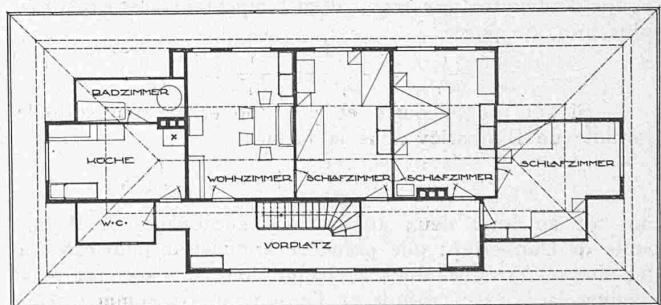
und 38. Grundrisse des Kosthauses. — Massstab 1:250.
